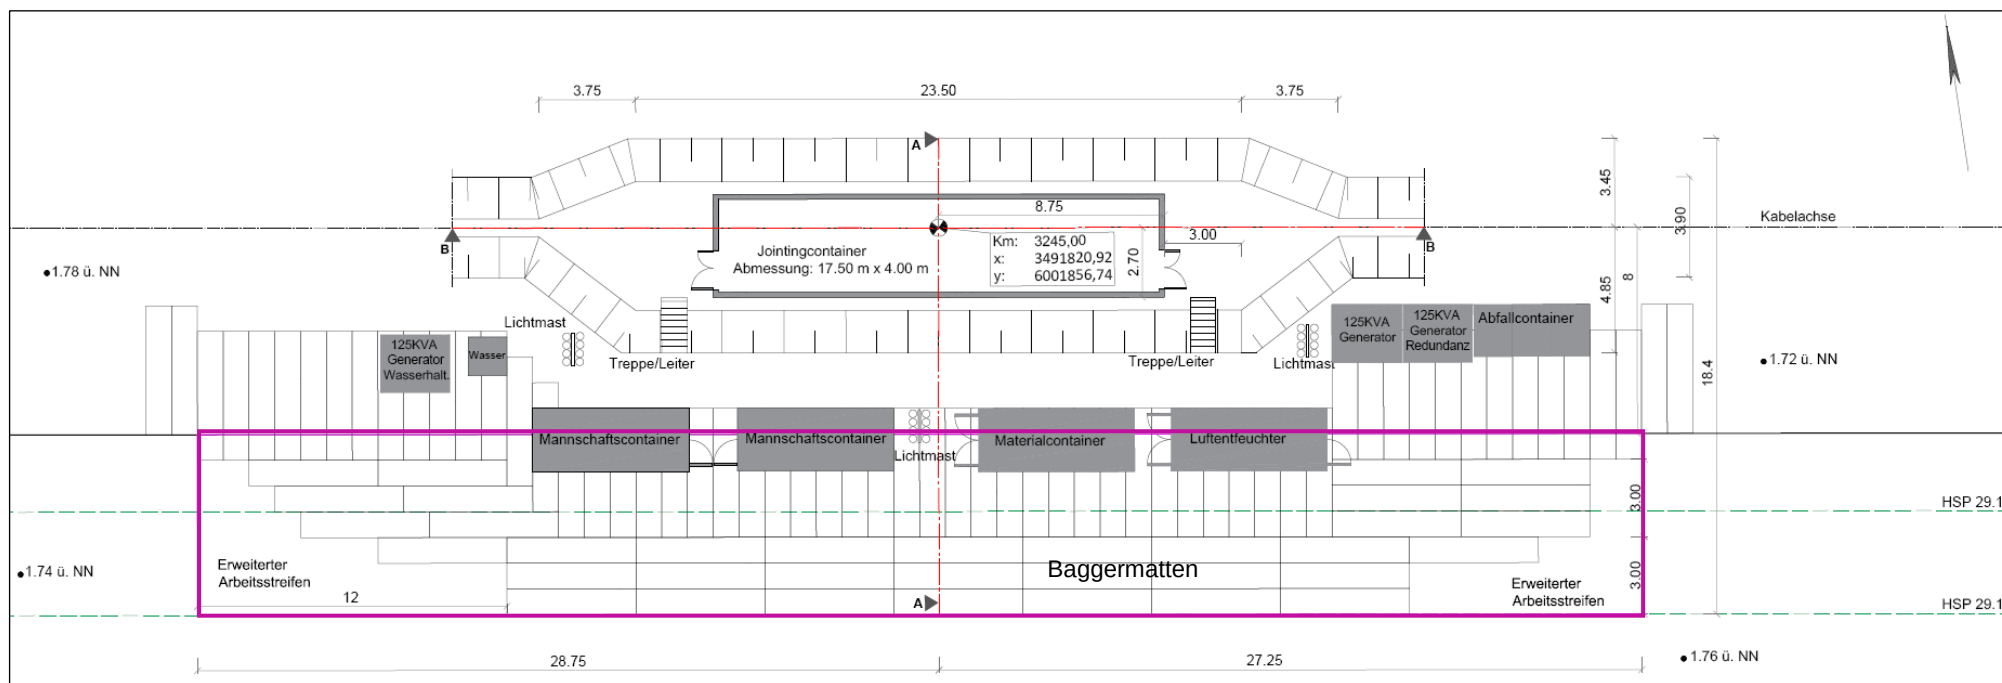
Grundriss BE-Fläche und Baugrube zur Herstellung des Kabelverbindingssystems (Prinzipiskizze)
